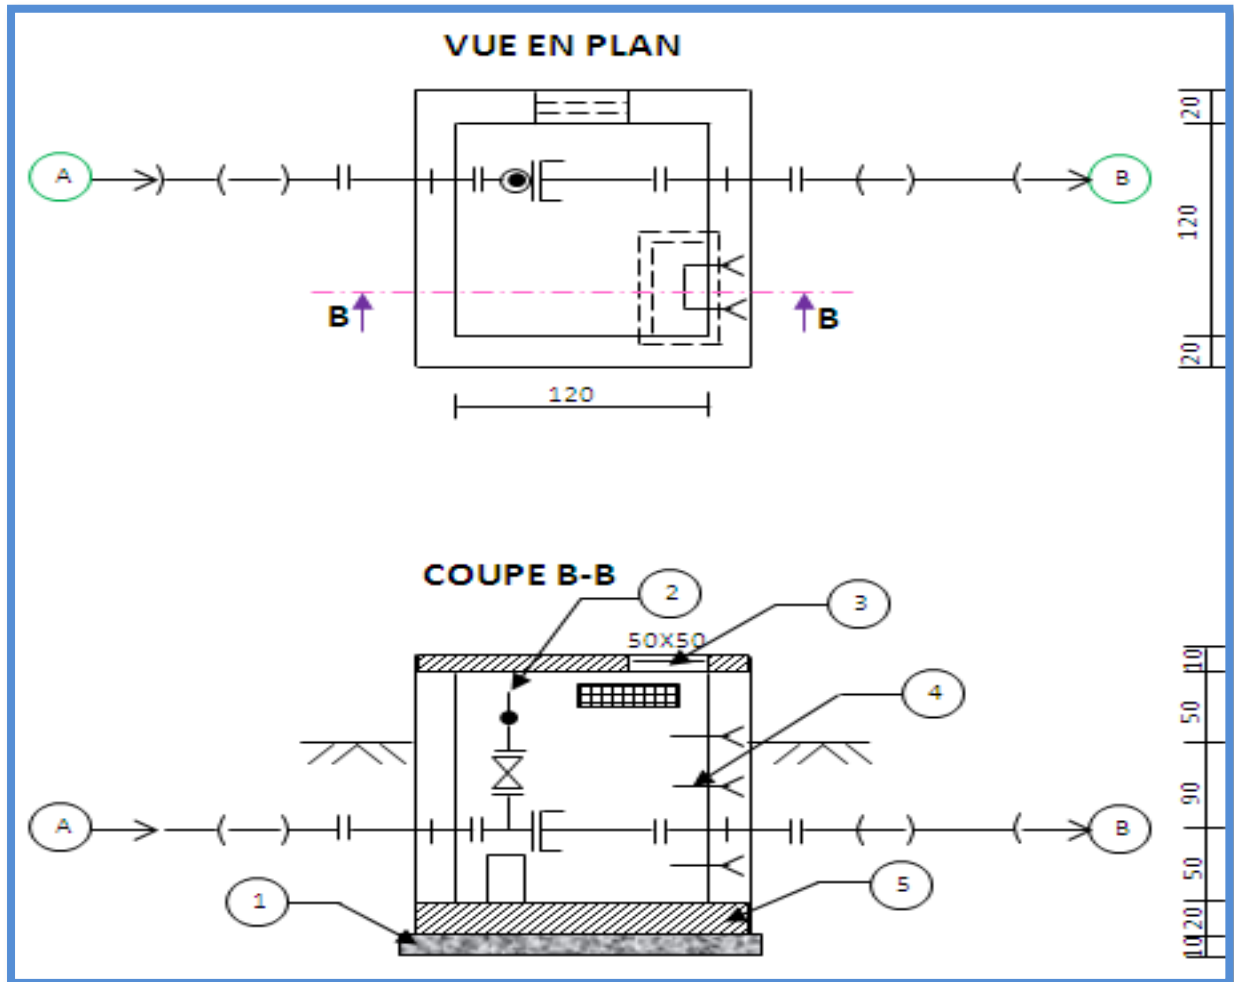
Vue en plan et coupe d'une ventouse.
